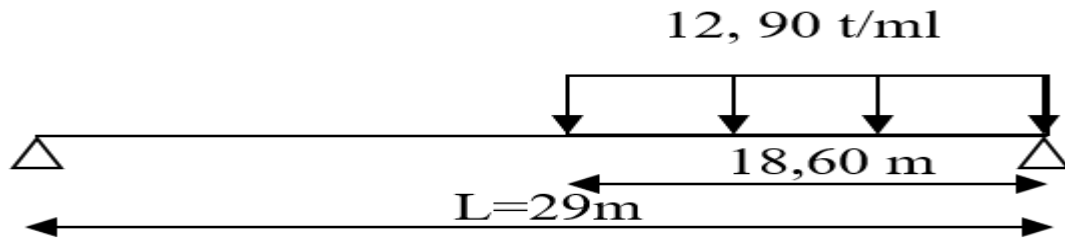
Poutre sous la surcharge D240 à ($x=0 L$).
